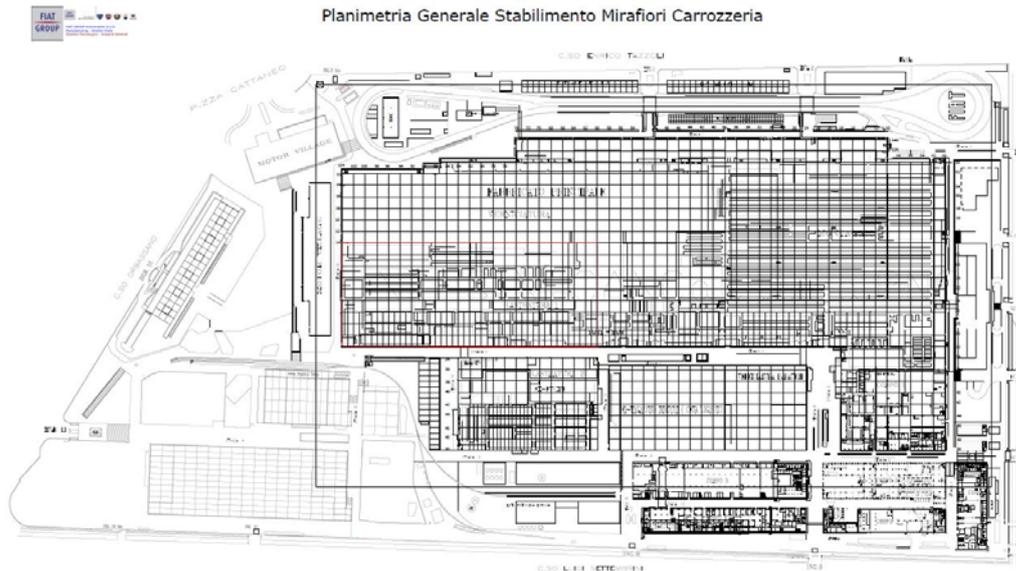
Planimetria Generale Stabilimento Mirafiori Carrozzeria da CAD-Fonte: documentazione FCA
